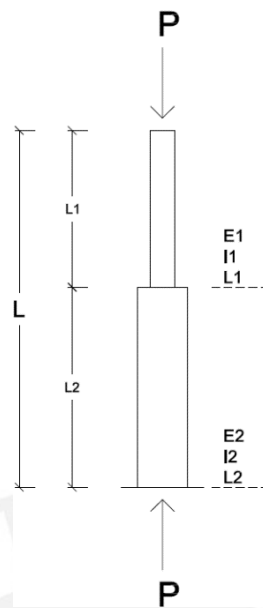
Columna de sección compuesta. Apoyos empotrada-libre.
